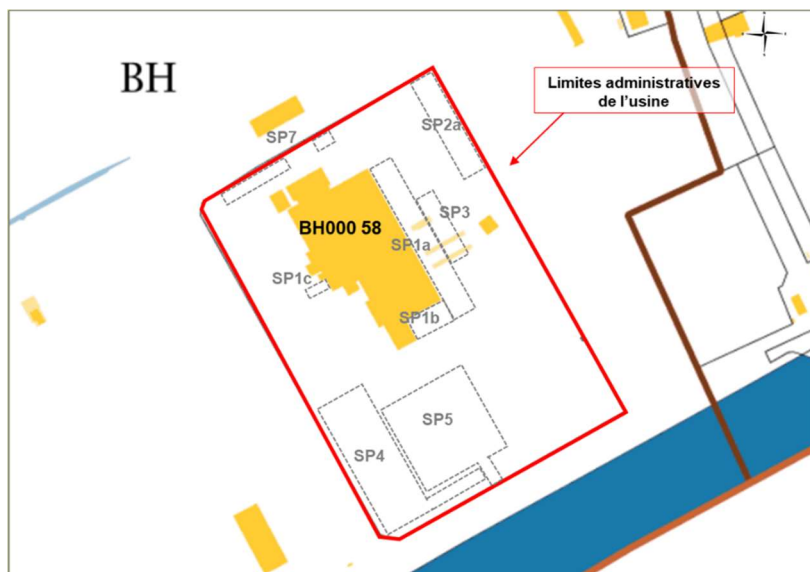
Localisation du site et des extensions et aménagements (SP), sur fond de plan cadastral (source : cadastre.gouv– échelle graphique)
